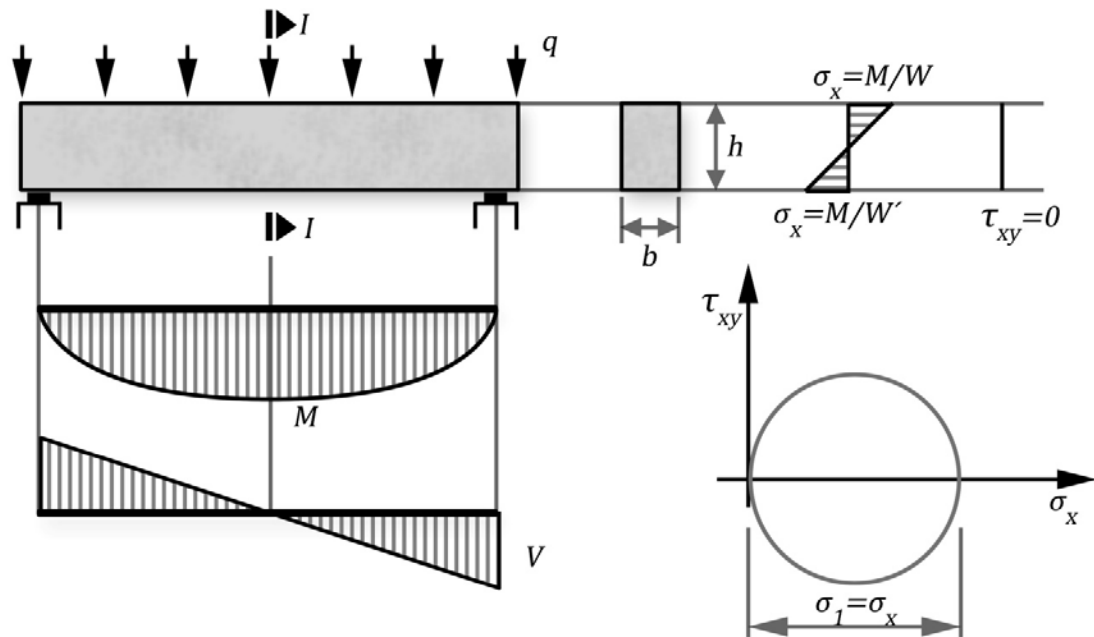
,4: Flexión simple. Estado tensional en la sección central. Fisuras por flexión.
